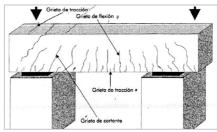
Fisuras por Cortante Fuente: Investigación
